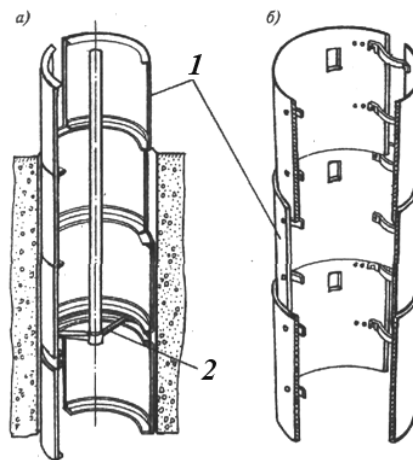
Кольцевая крепь: а – металлическая; б – стеклопластиковая; 1 – кольцо; 2 – спуско-подъемное устройство для монтажа и демонтажа крепи
